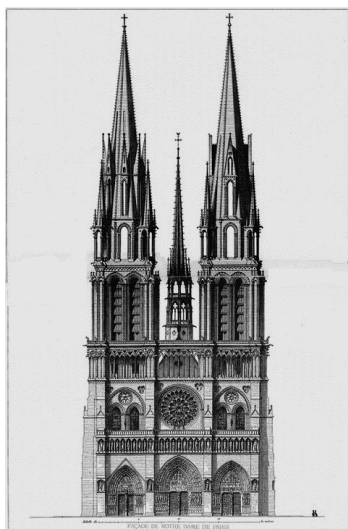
Proyecto para la restauración de la fachada de la Catedral de Notre Dame, por Viollet-Le-Duc.
